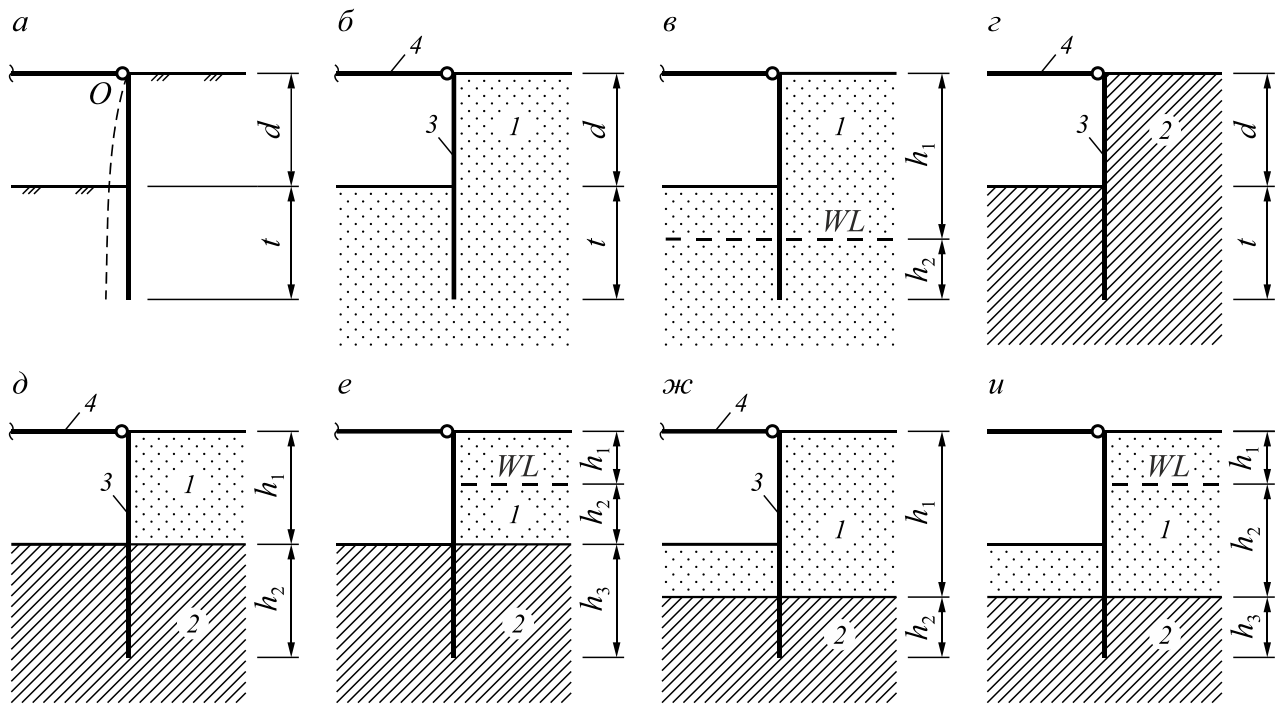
Схема деформирования раскрепленной шпунтовой стенки (а) и варианты грунтовых условий (б – и): 1 – сыпучий грунт ($\gamma_1, \gamma_s, e, \varphi_1$); 2 – водоупорный грунт (γ_2, φ_2, c_2); 3 – шпунт; 4 – распорка
